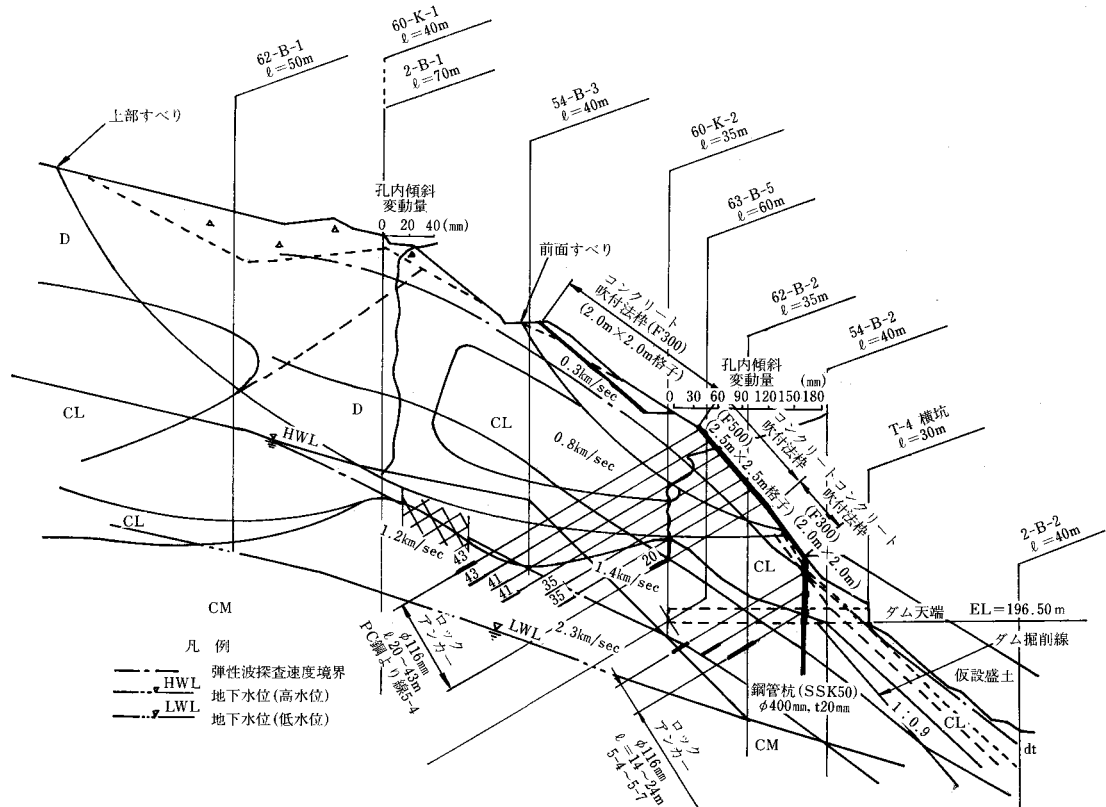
ダムサイト左岸地すべり対策工計画断面図 (S = 1 : 500)
